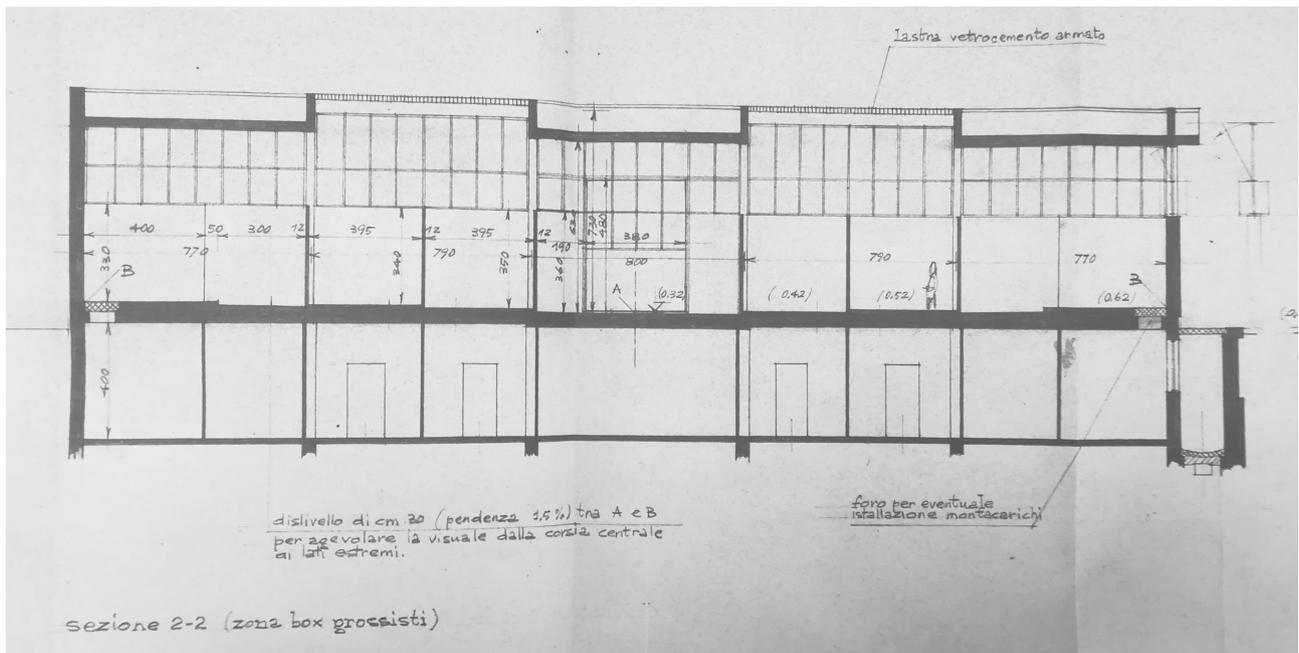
Progetto preliminare per il Mercato dei Fiori, sezione trasversale, arch. Cesare Bersia , *Archivio storico di Torino
